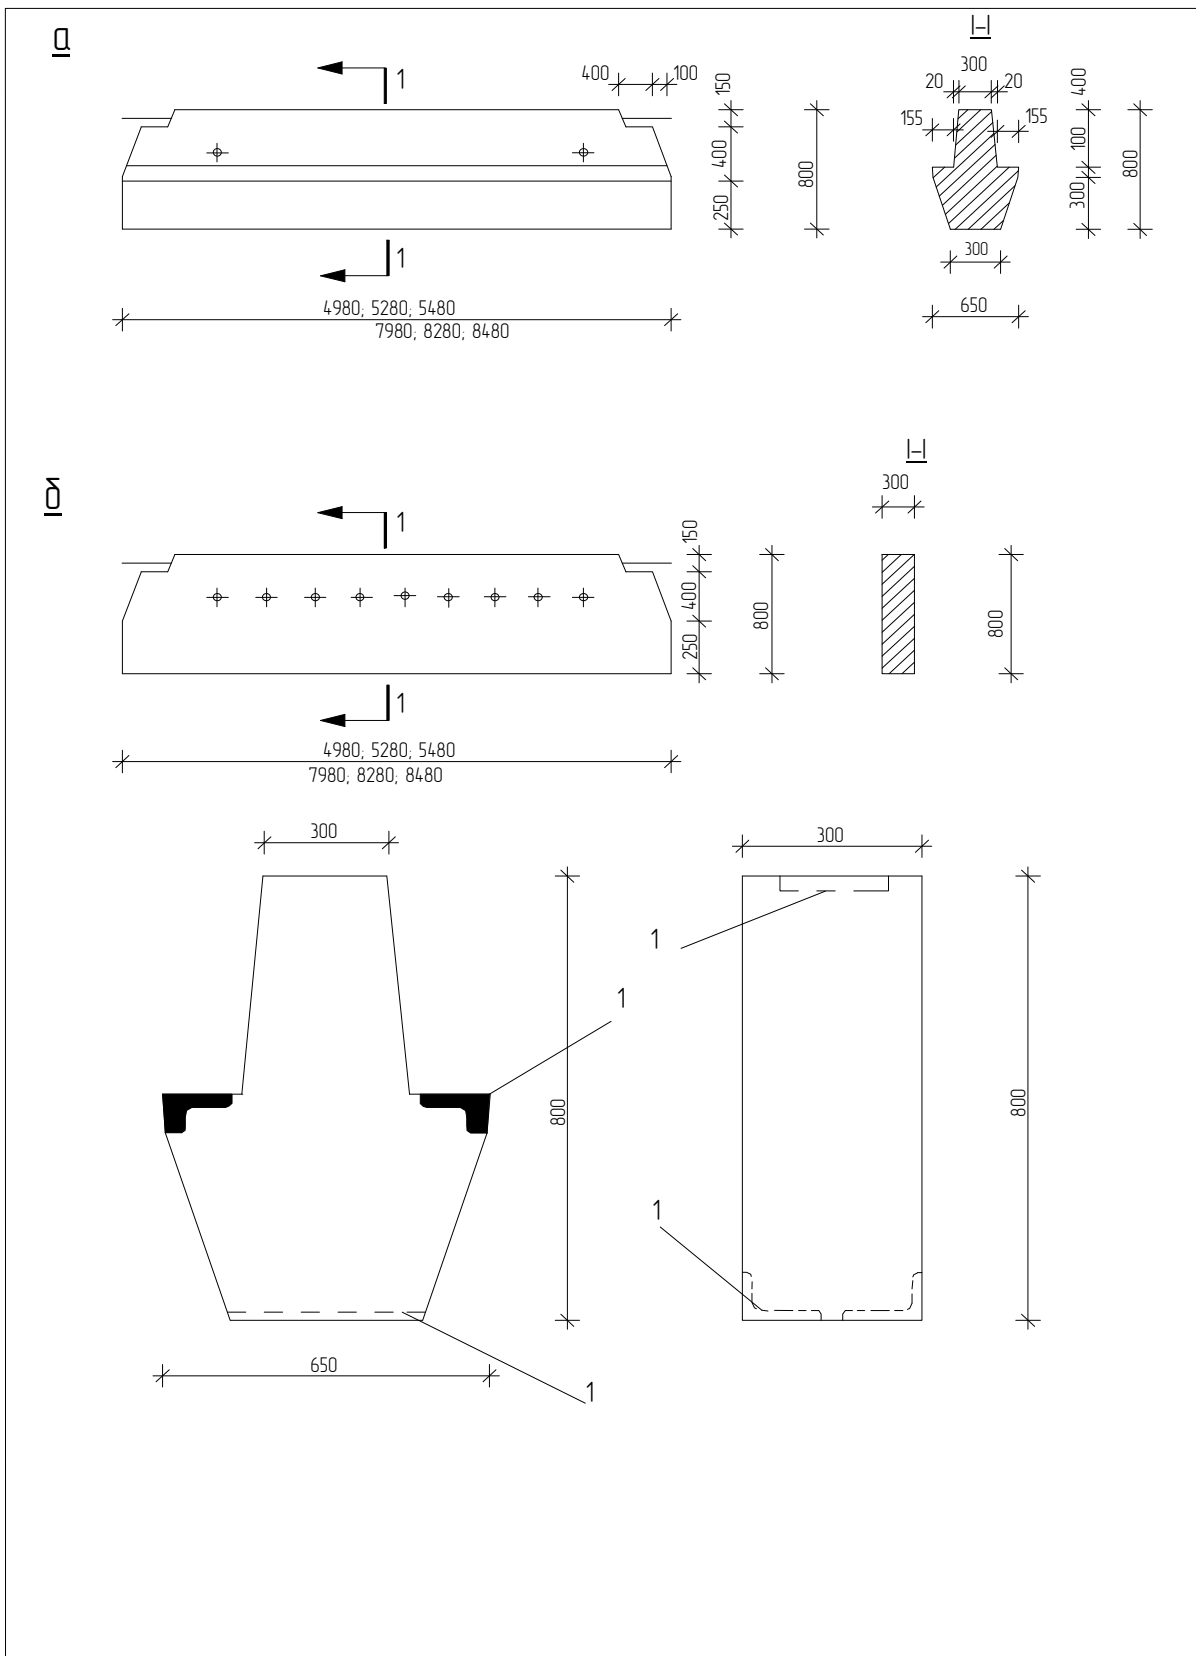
Залізобетонні ригелі перекриття багатопверхових промислових будівель; а – ригель з полицями для опирання плит перекриття; б – ригель прямокутного перерізу; 1 – закладні елементи
